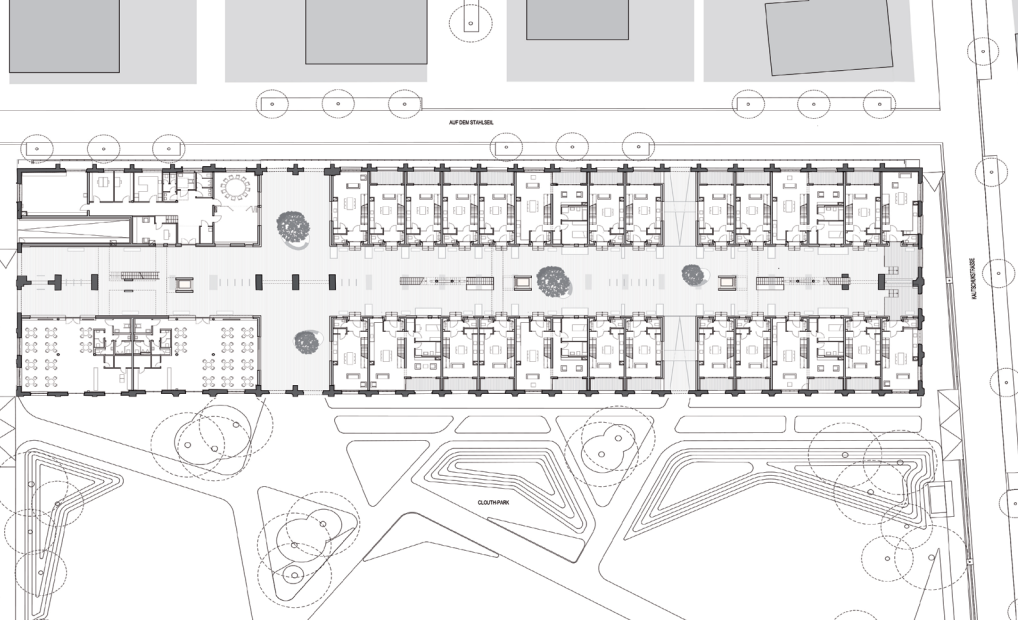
Grundriss Erdgeschoss Halle 17
